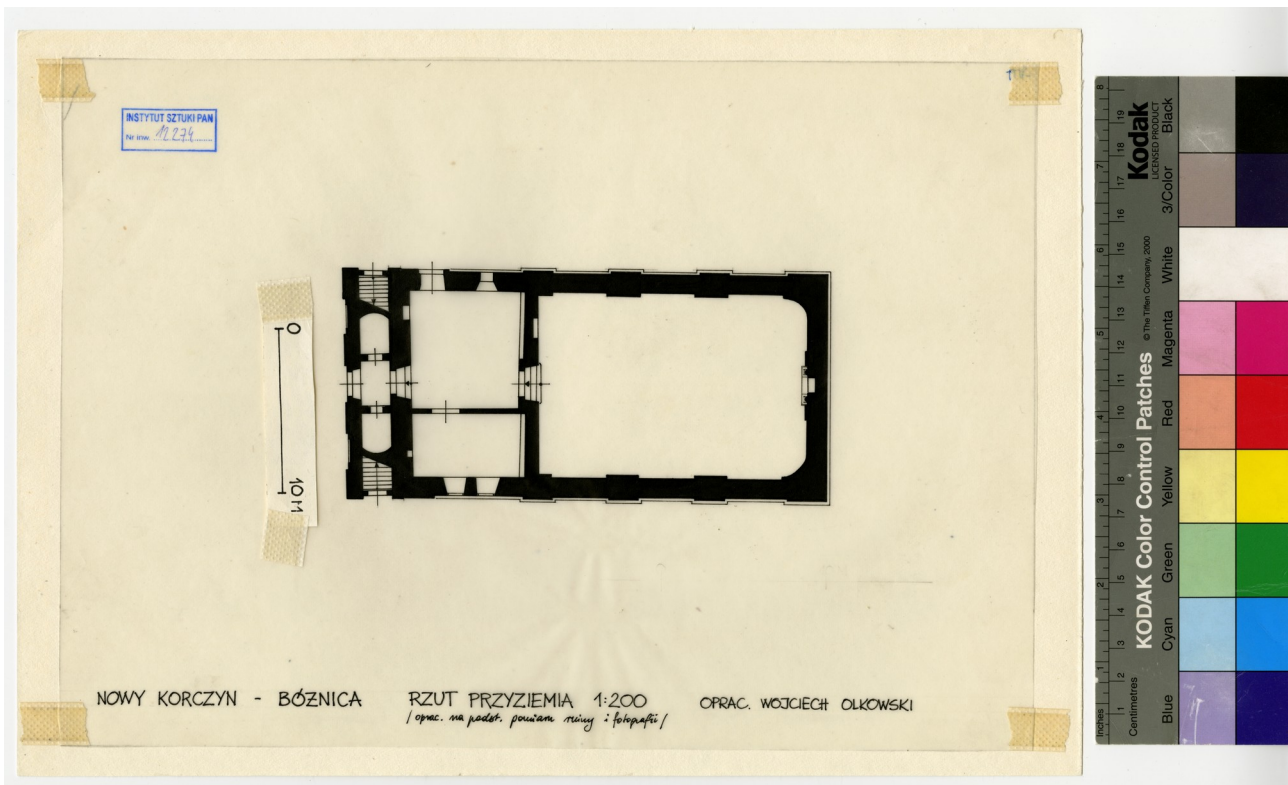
Grundriss Erdgeschoss 1987
